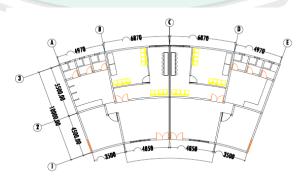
Denah Bangunan Guest House (Sumber: <u>Hasil</u> Rancangan, 2012)
